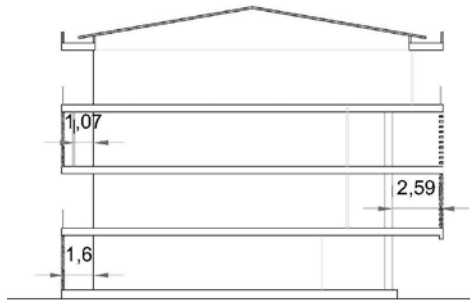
Proporciones de instalación de fachadas verdes instaladas
